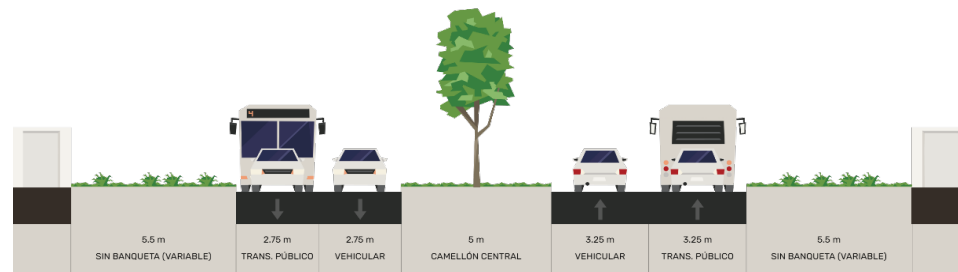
Sección vial Av. Heroico Colegio Militar.
